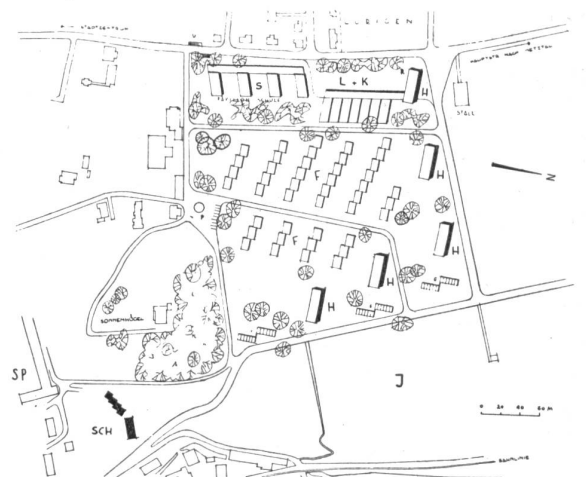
Studie zur Ueberbauung des «Buchholz»: H Hochbebauung, F Flachbebauung, S Schule, L + K Läden und Kleingewerbe, R Restaurant, J Areal der Heil- und Pflegeanstalt, evtl. Industrie, SCH Schwesternhaus, SP Spitalareal.
